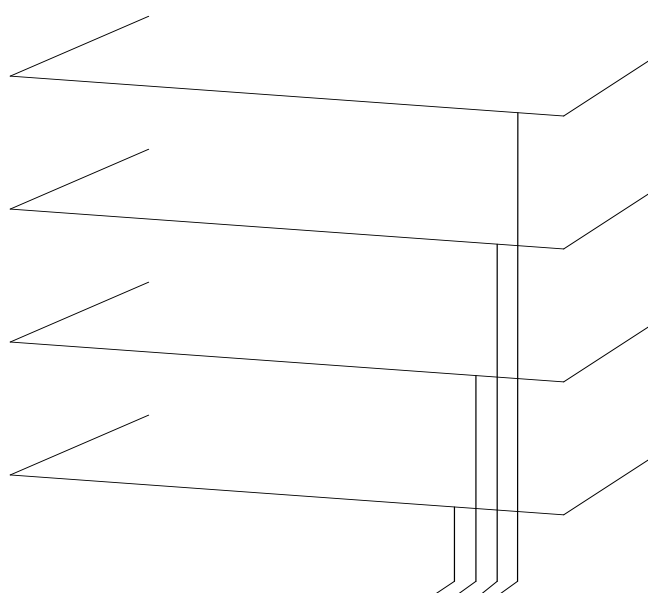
Схема полукольцевого расположения сухотрубов с подпитывающей системой от пожарного автомобиля
